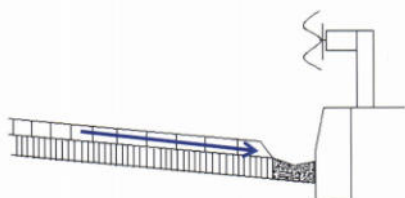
Открытый железобетонный лоток, установленный в нижнем слое покрытия
